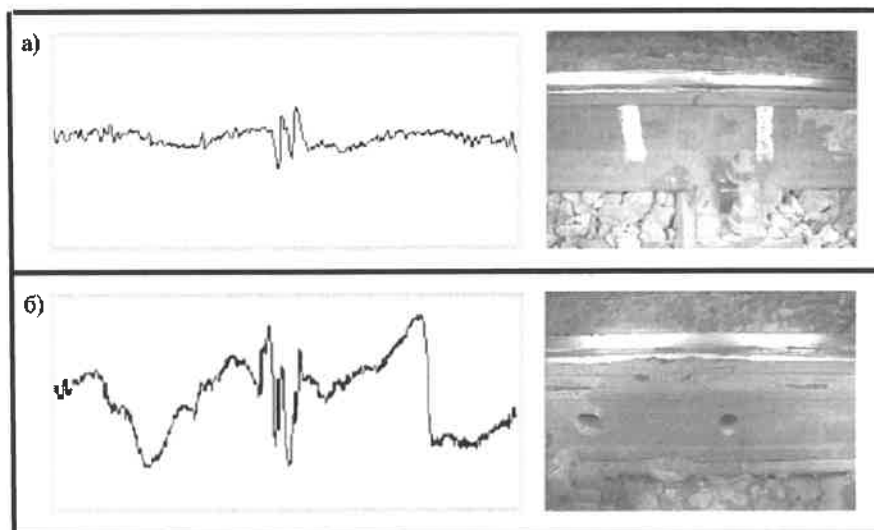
Магнитограммы сварных стыков рельсов:
